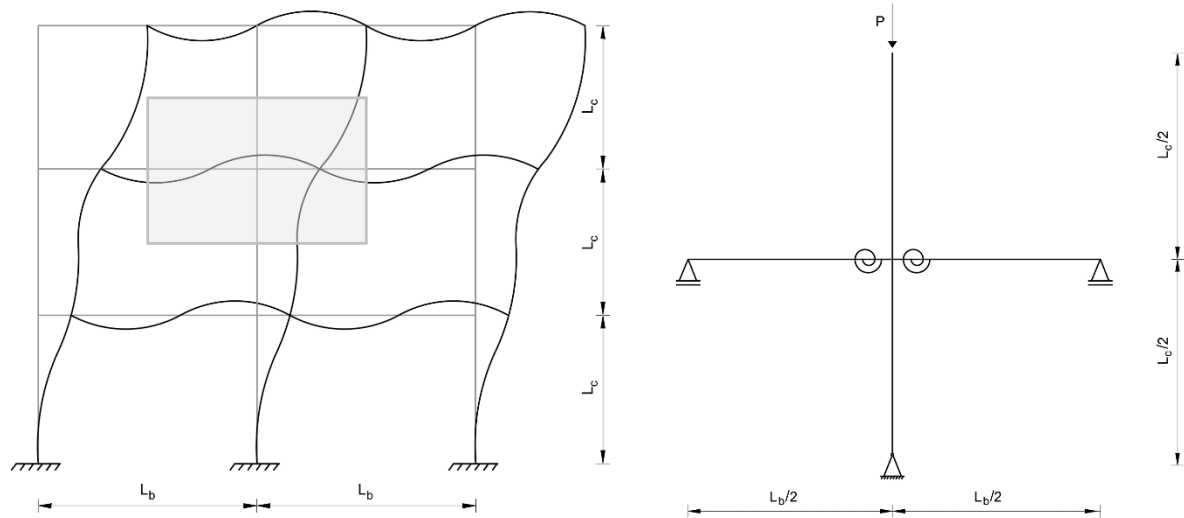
Modo crítico de instabilidade de um pórtico plano regular não contraventado e correspondente subestrutura arquétipo
